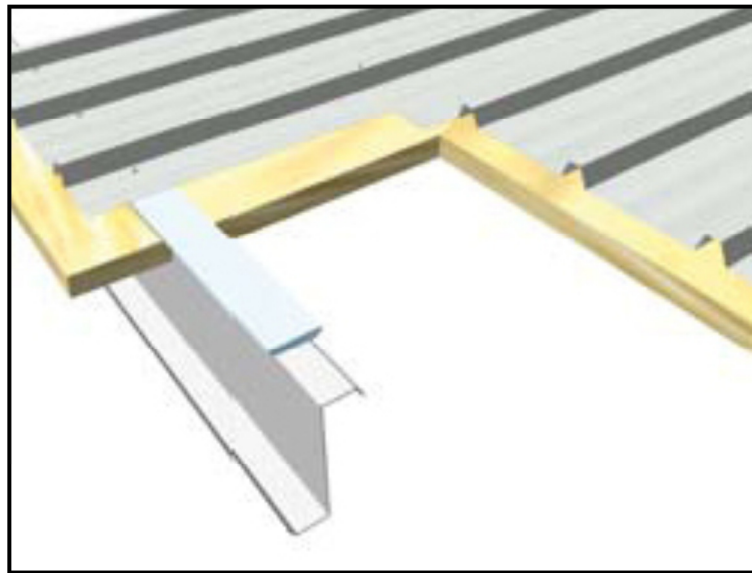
Roof system - TIPO 1: *Screwed Down Roof
